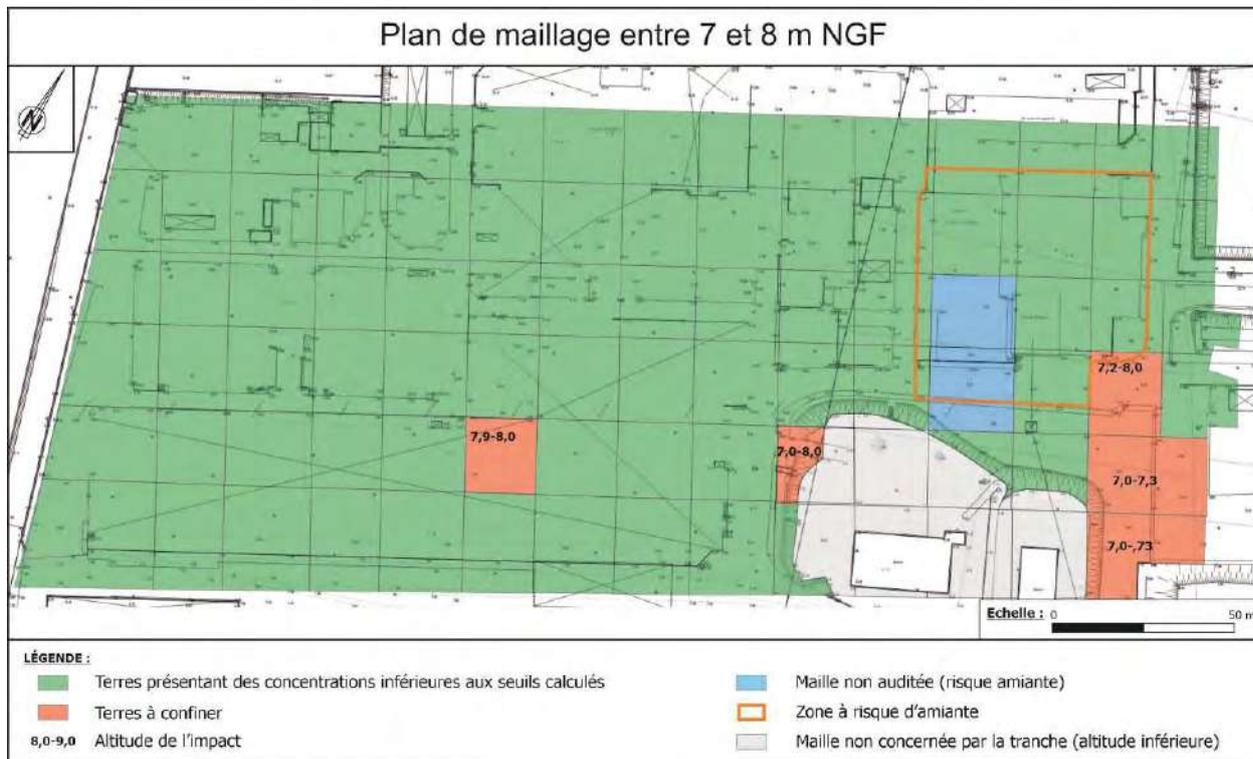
Plan de maillage entre 7 et 8 m NGF
